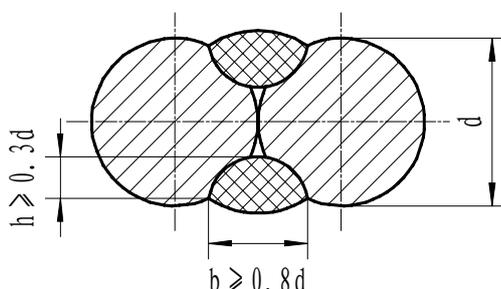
钢筋搭接、帮条焊接的焊缝
